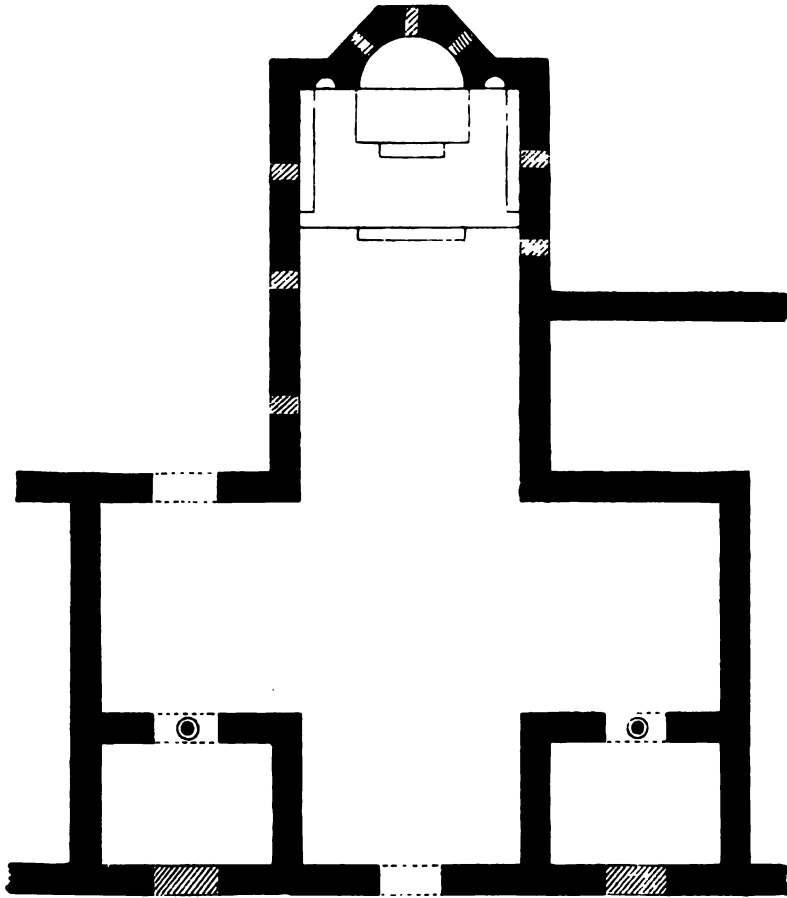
Trapeza zu Lawra, Grundriss-Skizze.
